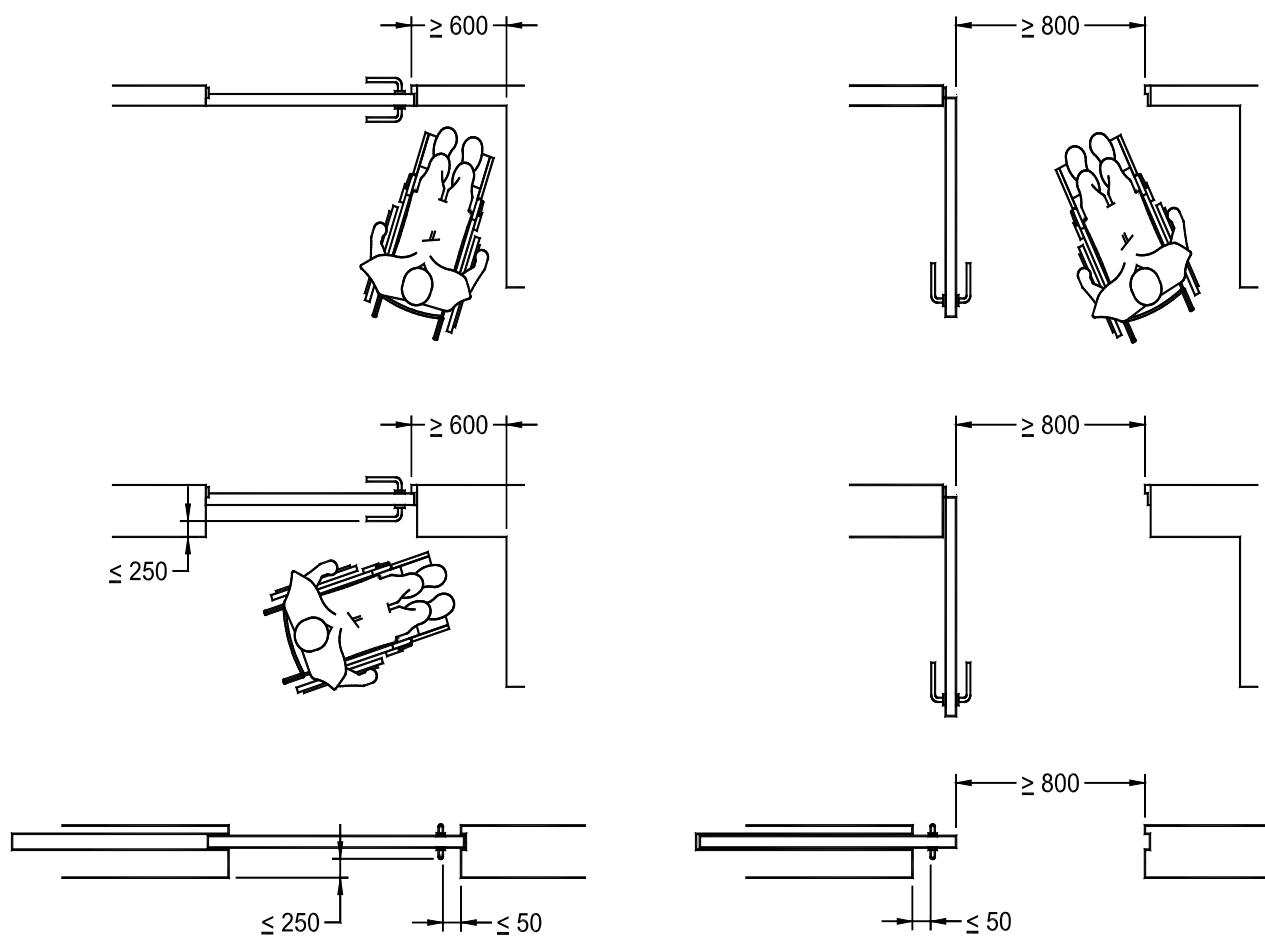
Ancho no obstruido de puertas de batiente y corredizas
